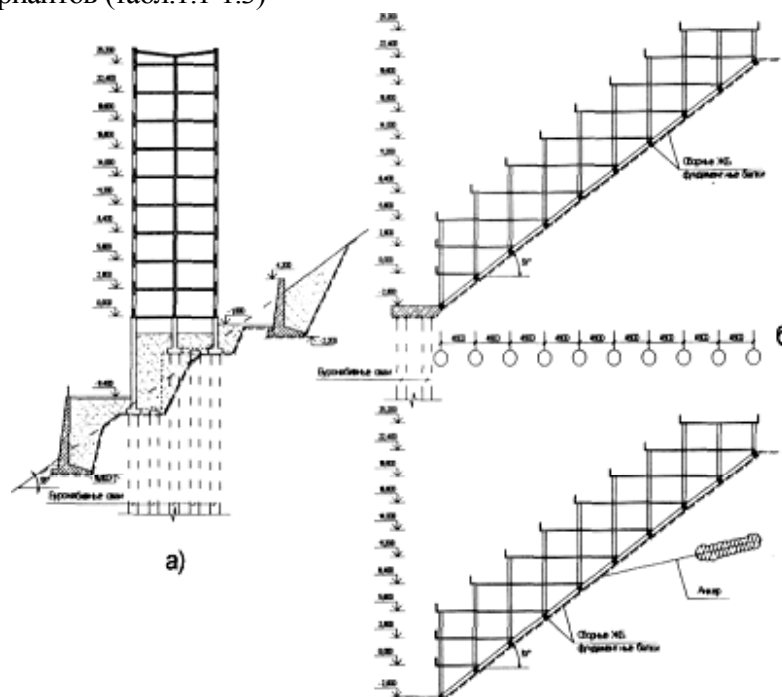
Варианты строительства зданий на крутом рельефе: а - типовое здание на склоне; б - террасное здание на склоне с удерживающей конструкцией в виде монолитного ростверка; в - террасное здание на склоне с анкерной удерживающей конструкцией
